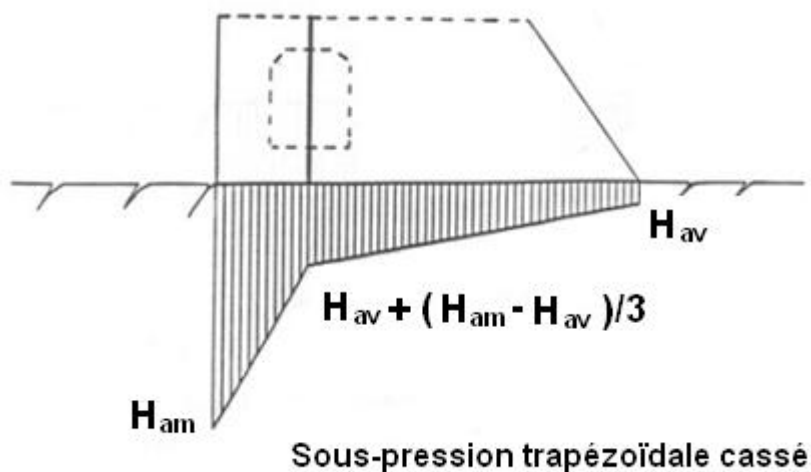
4 - Drainage efficace, Sous-pression au contact fondation-rocher
